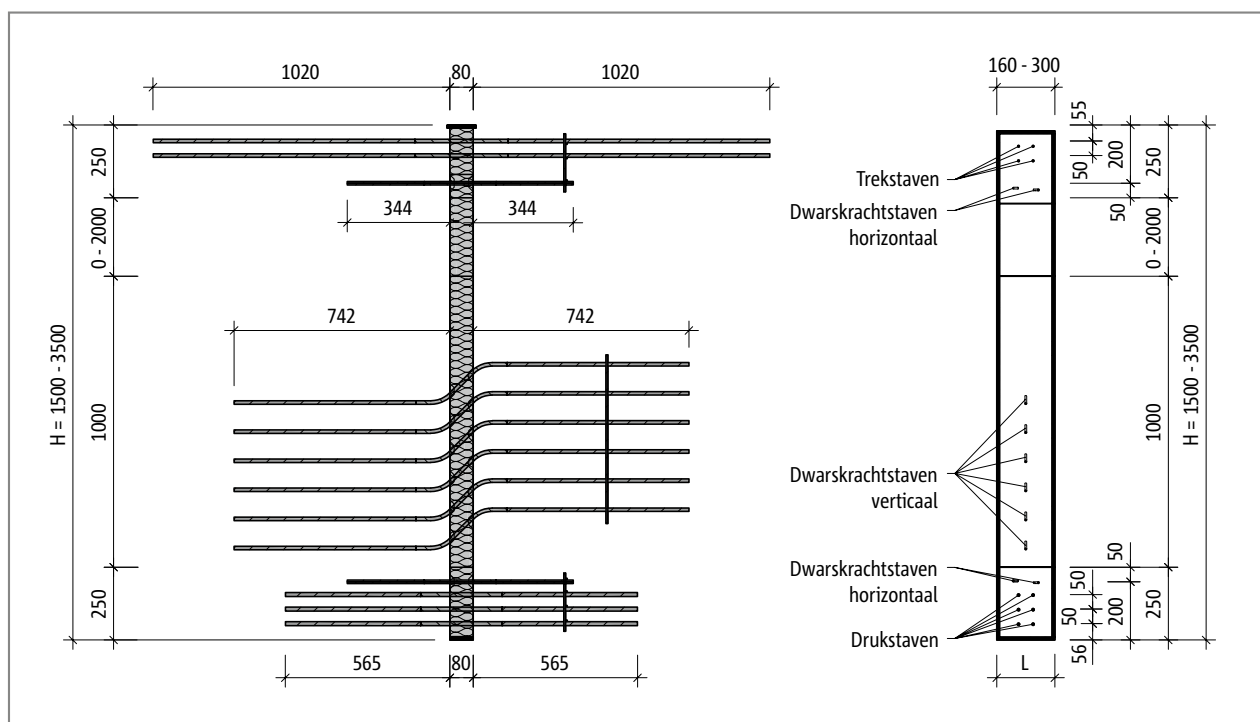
Schöck Isokorb® T type W-M1: Bovenaanzicht
